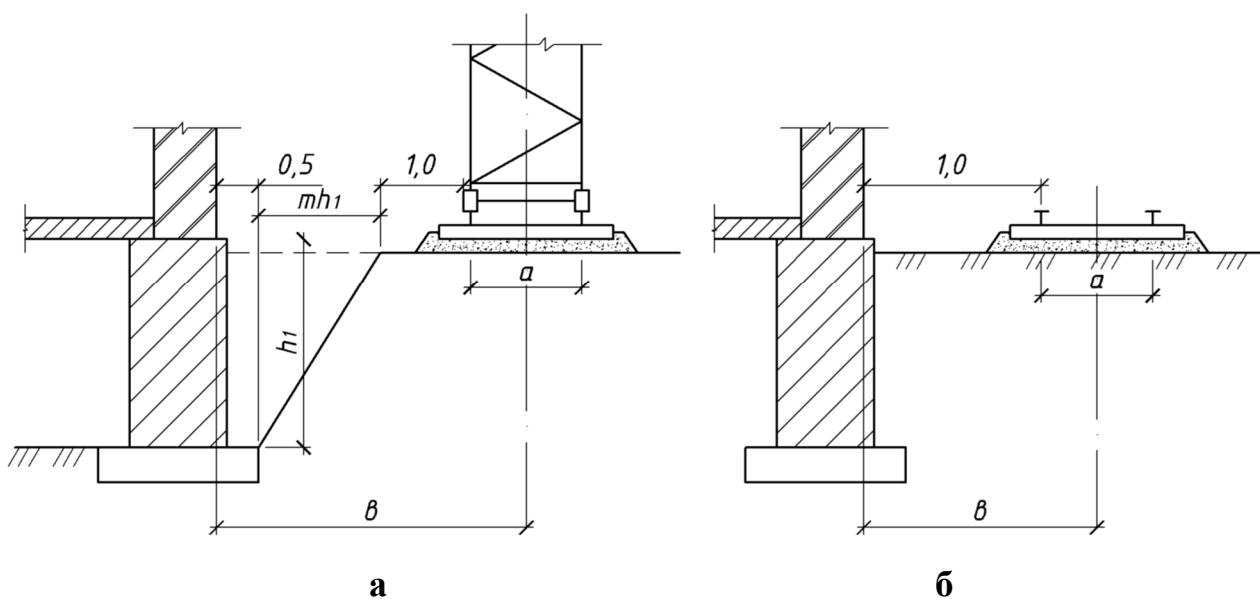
Схеми встановлення баштового крана у будівлі:
